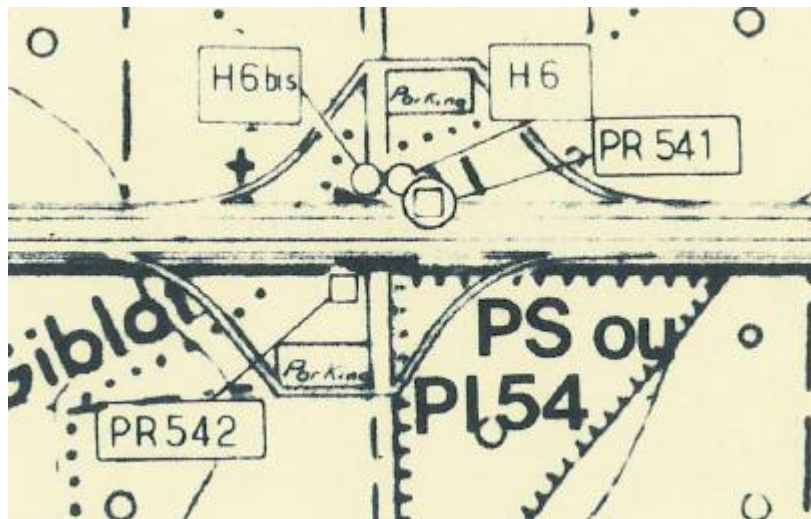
Plan d'implantation des sondages de la campagne de 1979
